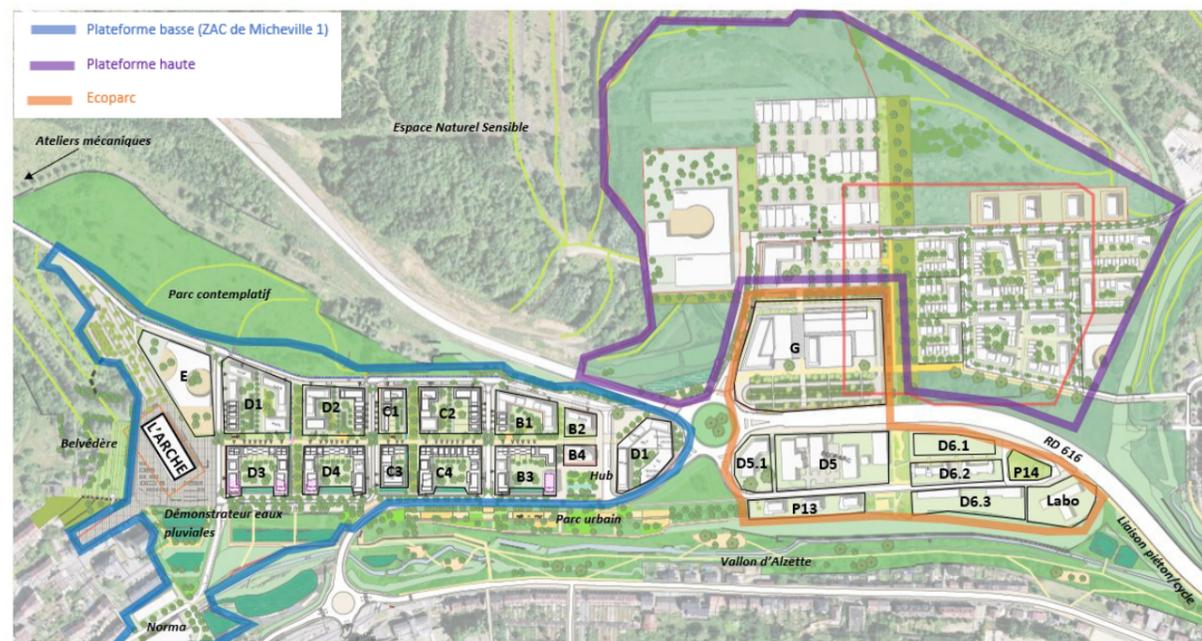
Plan du projet Micheville (source : agence Devillers et EPA Alzette Belval)
